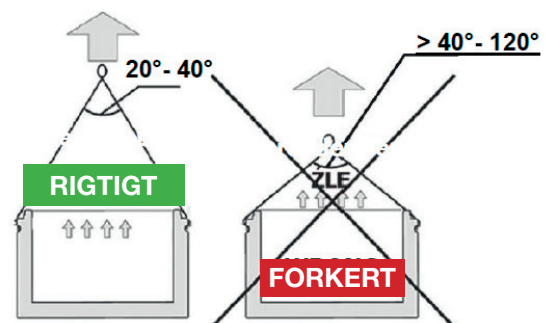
Løft af præfabrikerede betonelementer med flergrenede løftkæder
